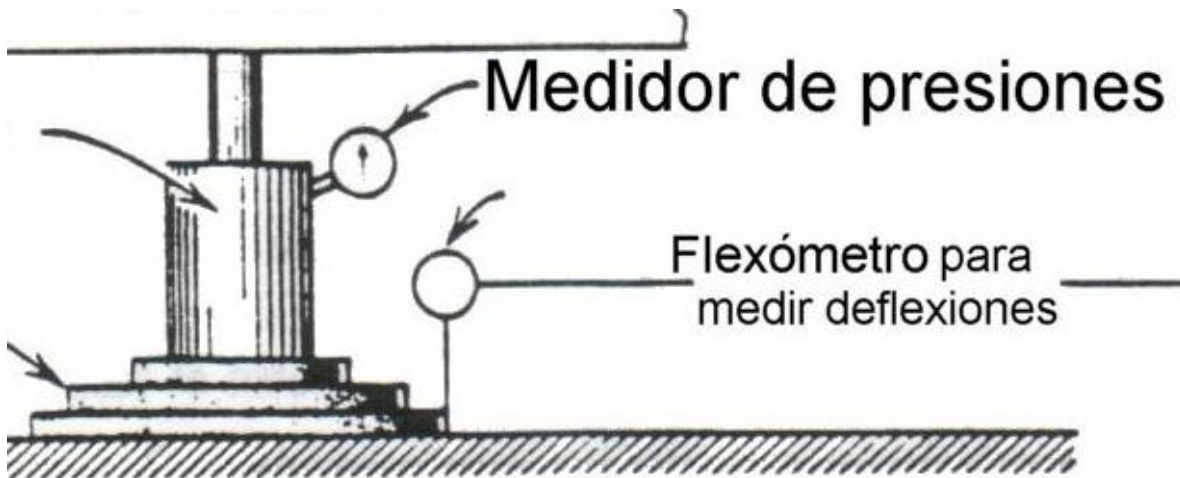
b.7 Prueba de placa en sub-base pavimento rígido.
